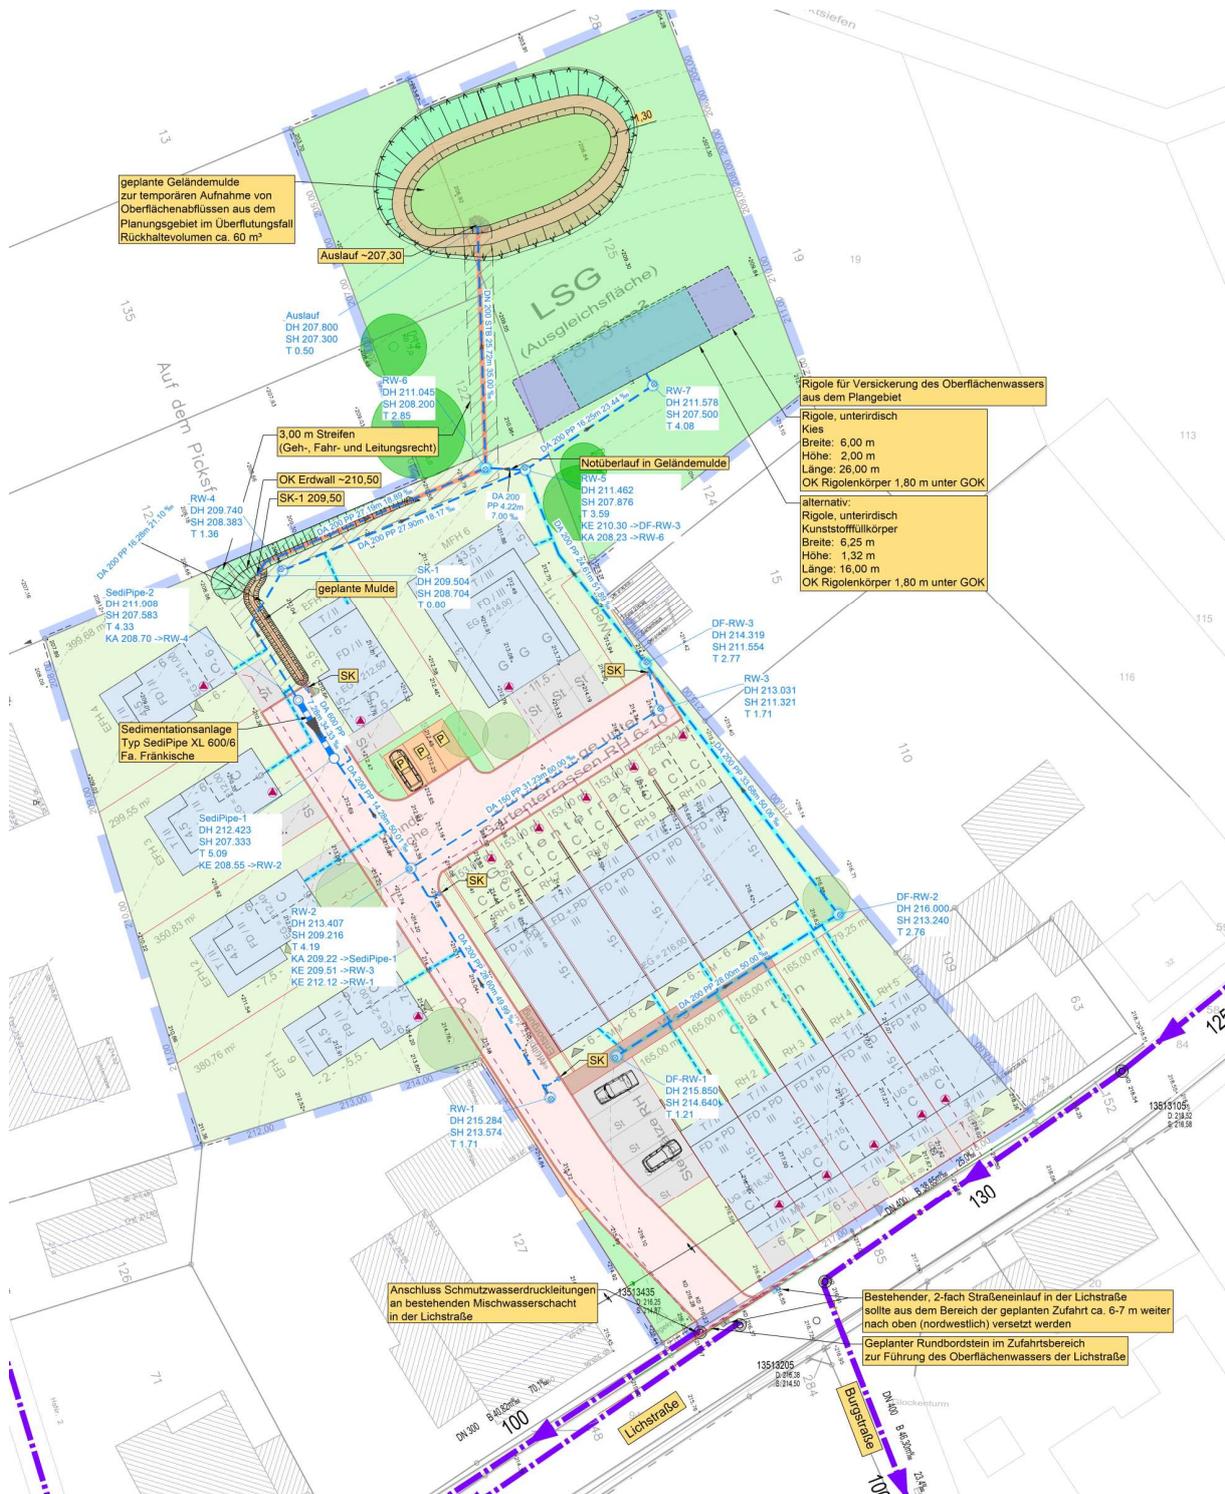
Fachplanung zur Entwässerung, Planausschnitt (Quelle: Ingenieurbüro Brenner GmbH)
